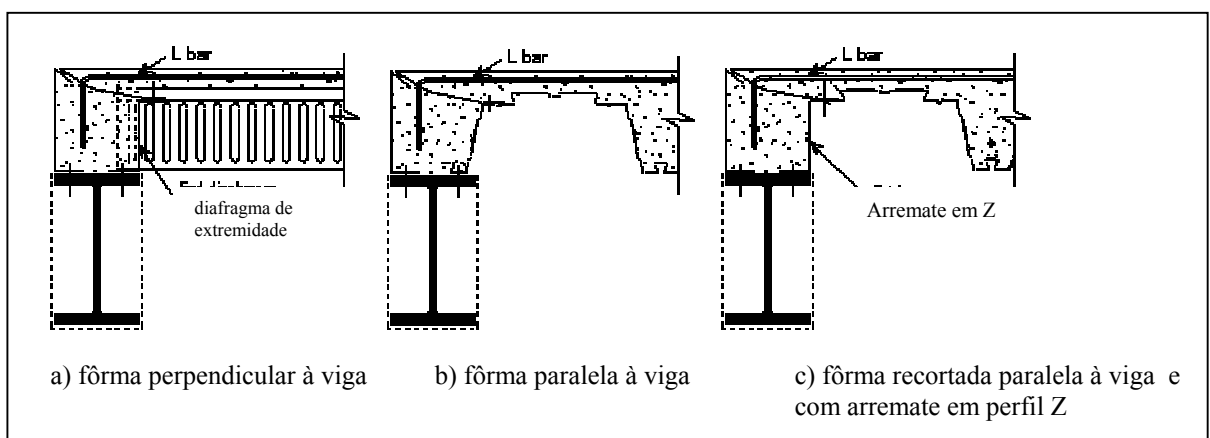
Viga de borda rebaixada, em perfil I, dimensionada como viga de aço isolada (Fonte catálogo da CORUS)
